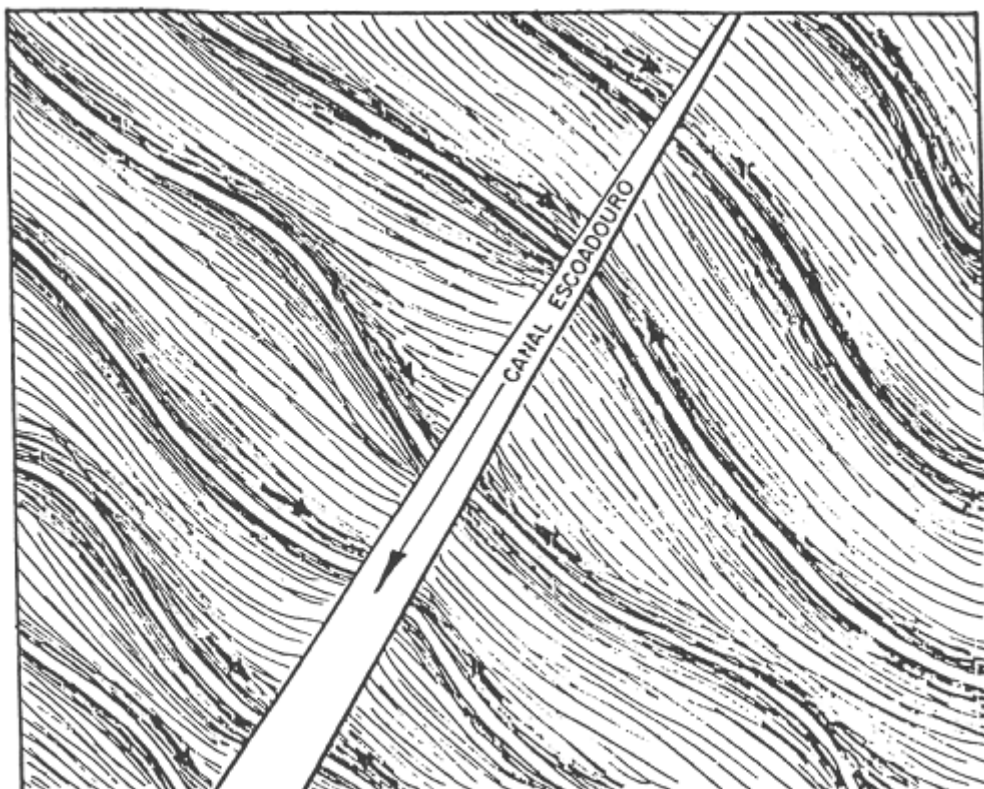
Esquema de construção de terraços em desnível ou de escoamento
